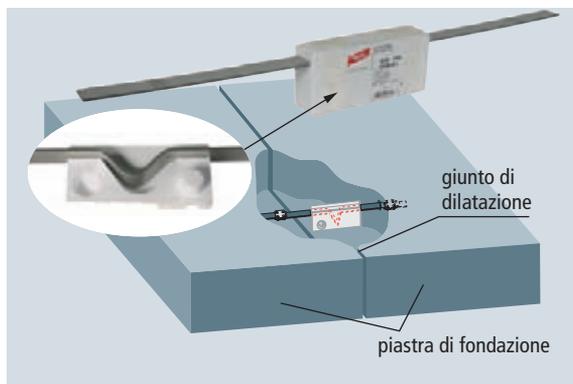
Collegamento di un dispersore di fondazione con un giunto di dilatazione
